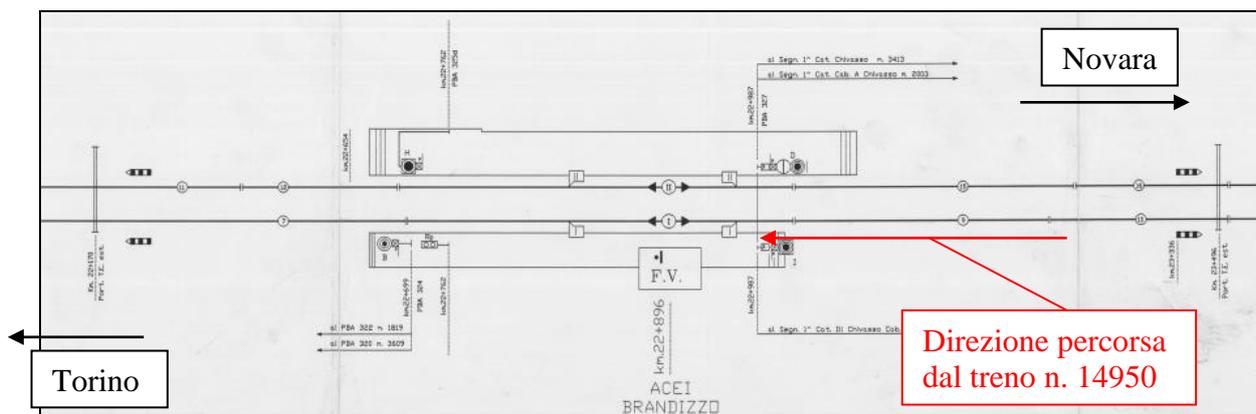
Piano Schematico della Stazione di Brandizzo
